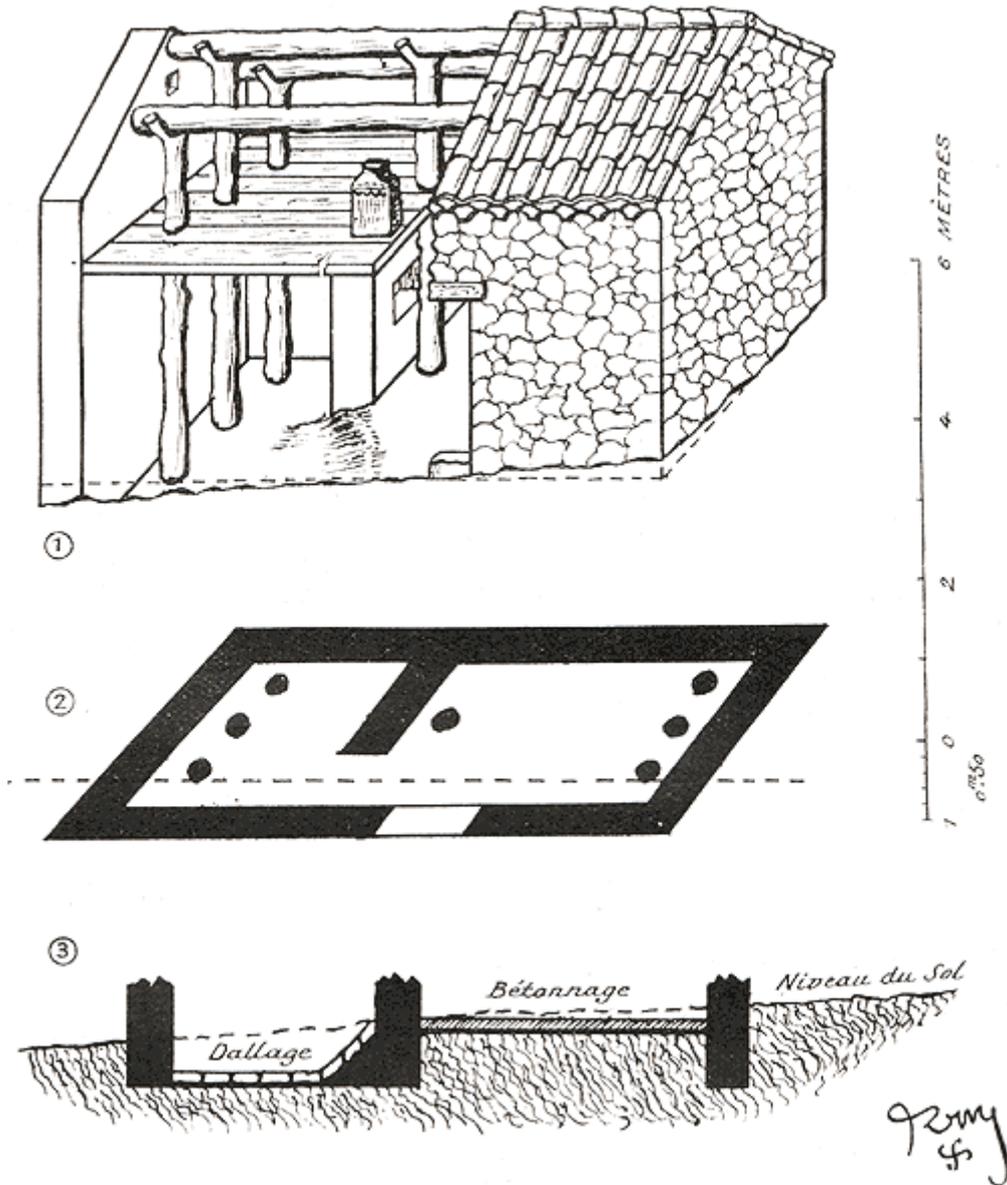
Vue cavalière, plan et coupe d'une maison kabyle.
